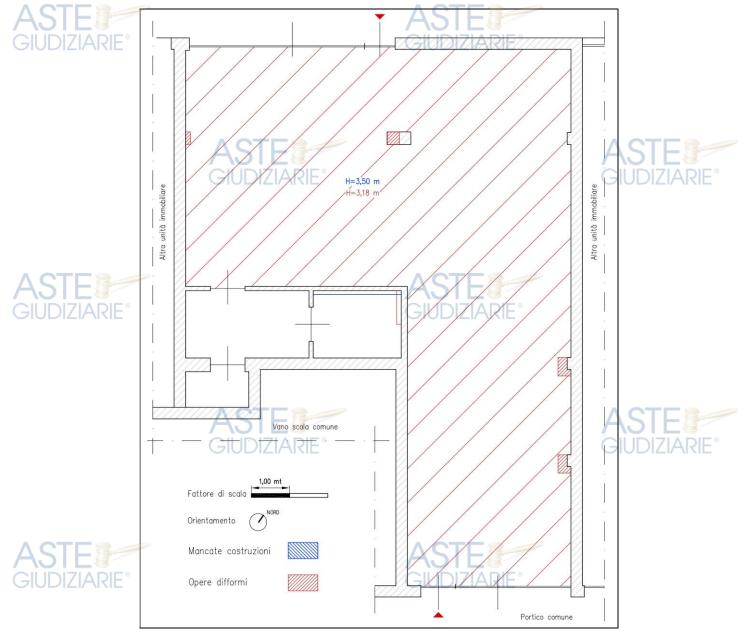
Pianta di confronto negozio con ultima planimetria catastale in atti
